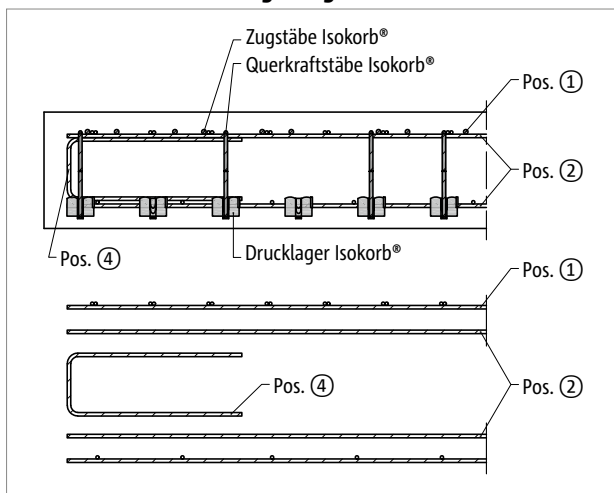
Schöck Isokorb® XT Typ K-M1 bis M10: Bauseitige Bewehrung balkonseitig im Schnitt A-A; Pos. 4 = konstruktive Randeinfassung am freien Rand
